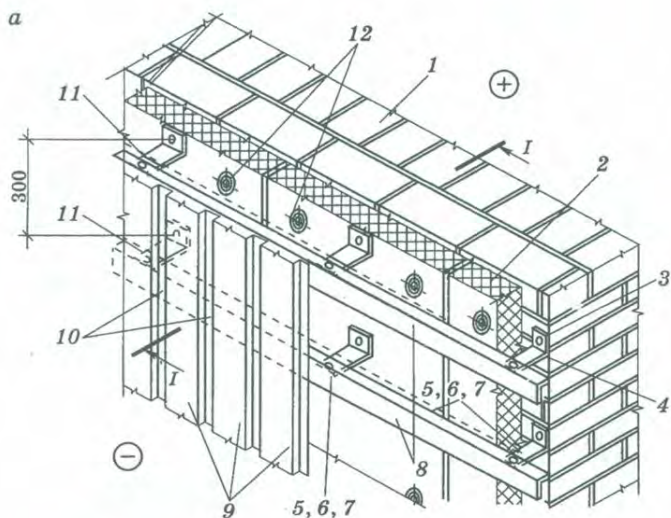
Наружная теплоизоляция стен здания «вентилируемый фасад»:
